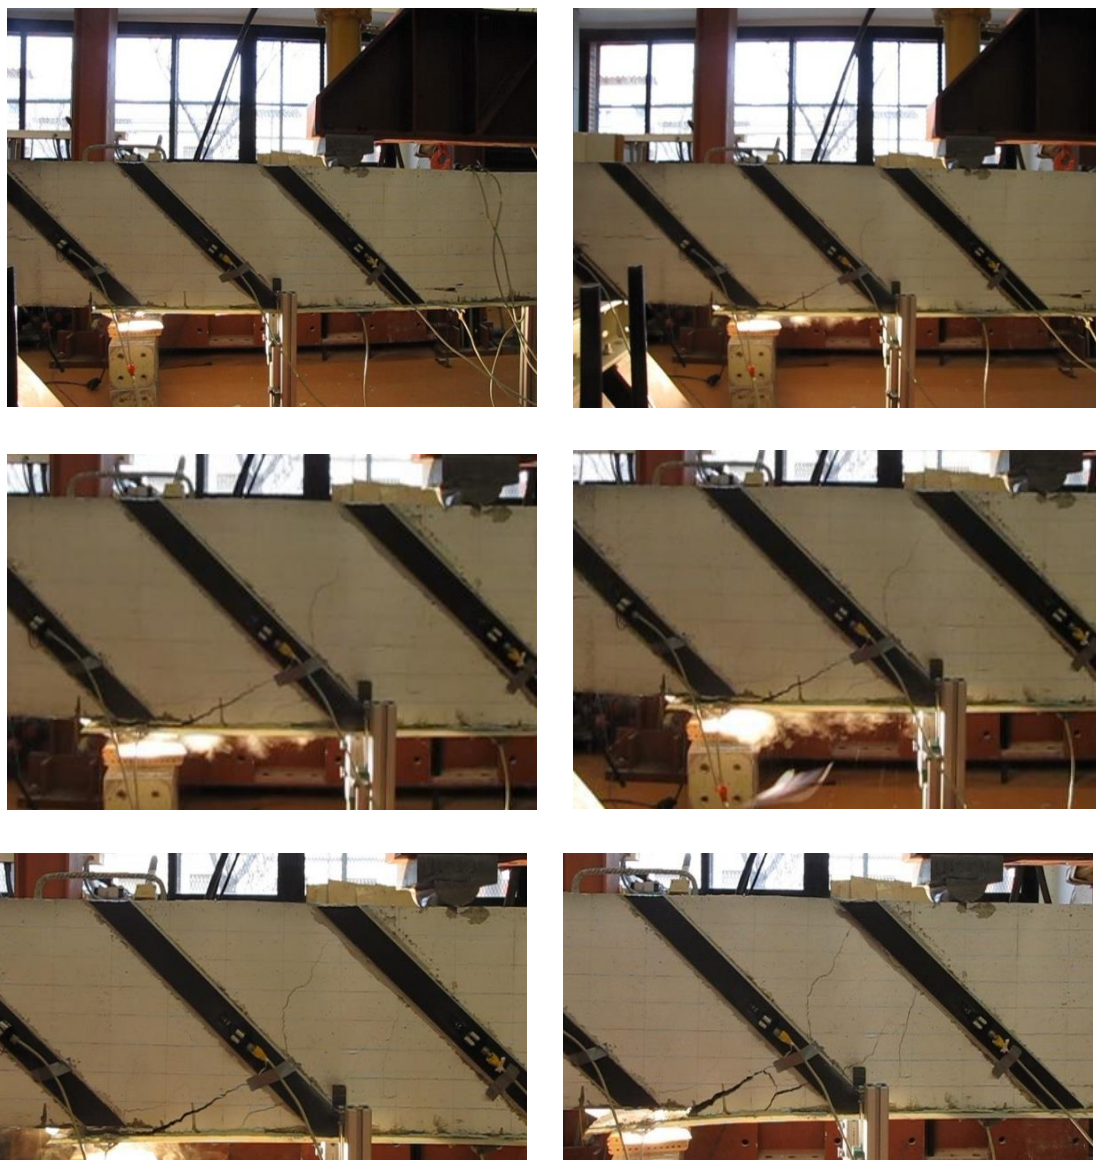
a) Tipo de falla en ensayo de viga CG09
